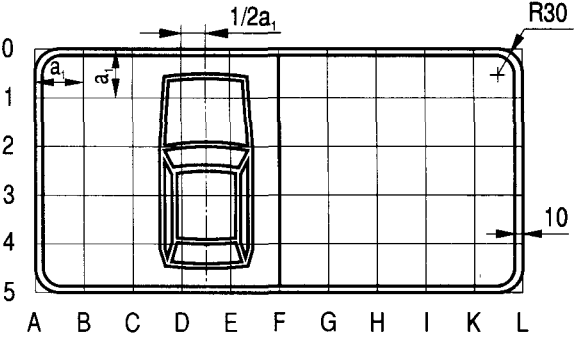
Konstrukcja tabliczki T-30f
